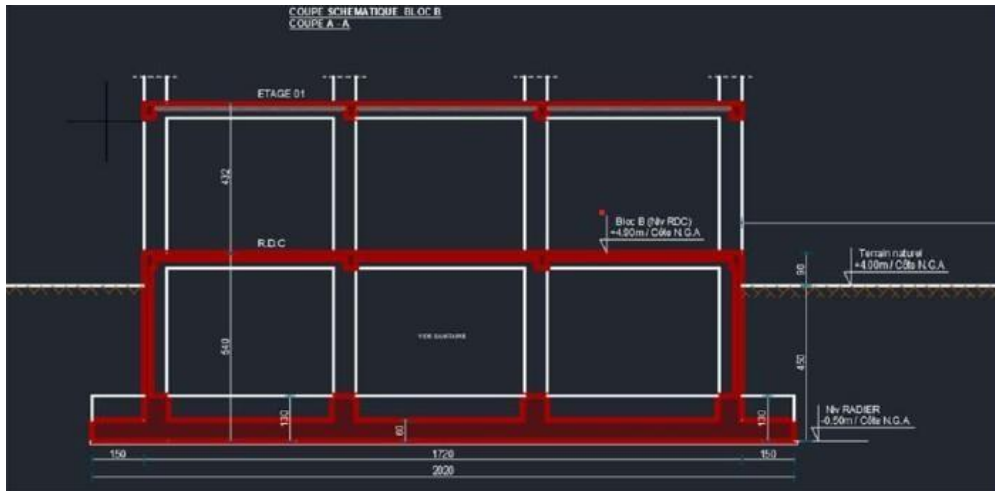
Coupe transversale au niveau radier et sous-sol (Bloc B ou central voir fig. 1).
